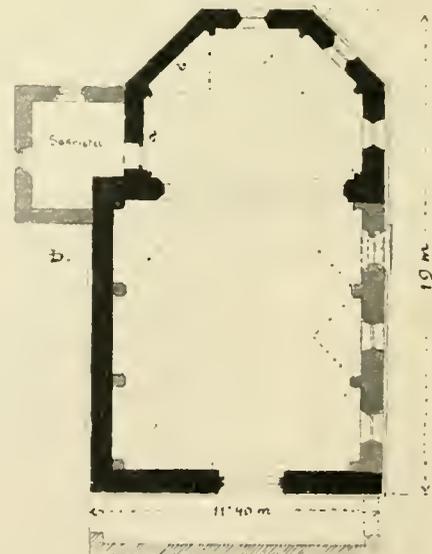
(St. Adalari im Pillerfeethale; Grundriß.)
